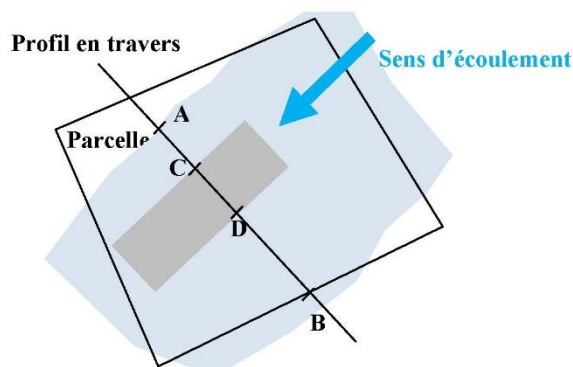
Largeur construction (CD) < 30 % de la largeur de la partie inondée sur la parcelle (AB) (zone inondable en bleu)
